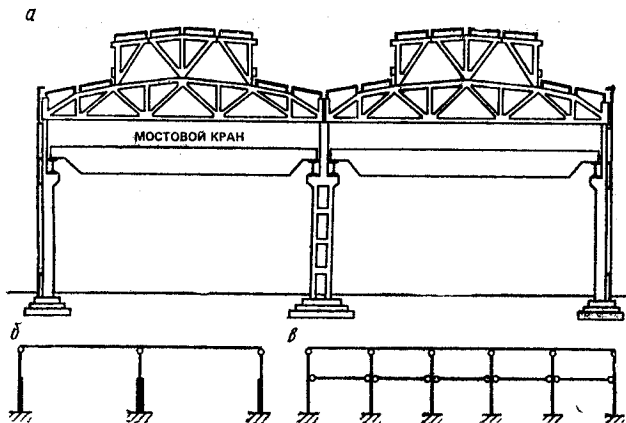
Одноэтажное промышленное здание с мостовыми кранами
